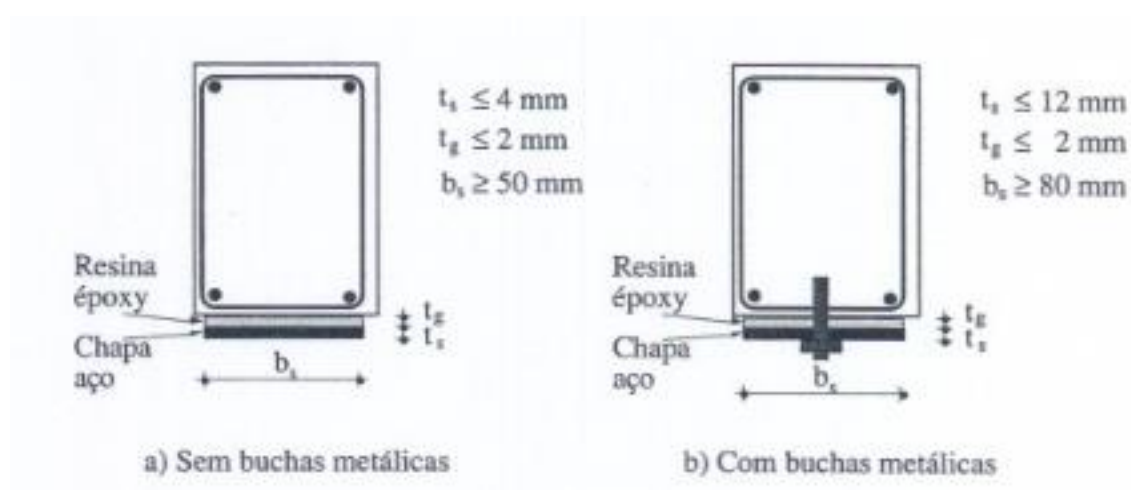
Dimensões recomendadas no reforço à flexão de uma viga em betão armado. (Gomes, A., Appleton, J.1997).
